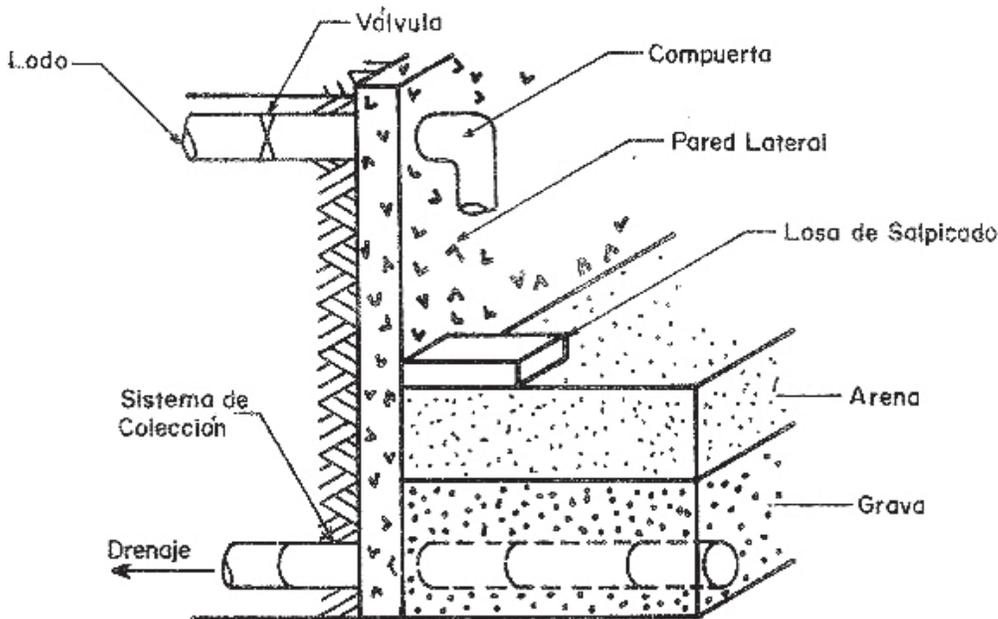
Lecho de secado de arena típico (CNA México, 2007)
